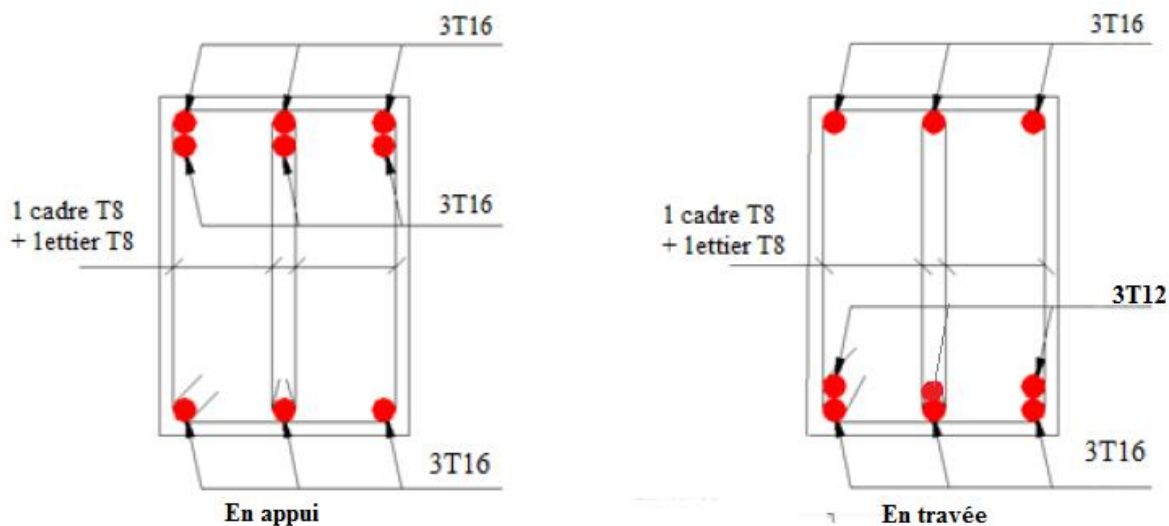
Ferrailage des Poutres porteuses de RDC, 1^{er}, 2^{eme} et 3^{eme} étages.
